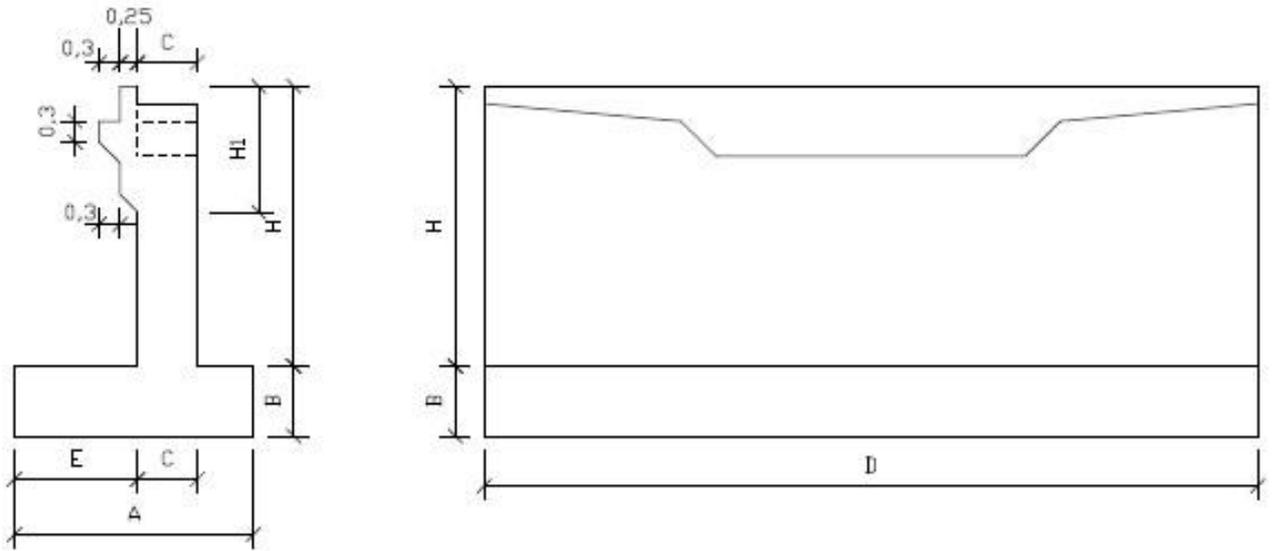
Detalle de la sección tipo de estribo cerrado.
